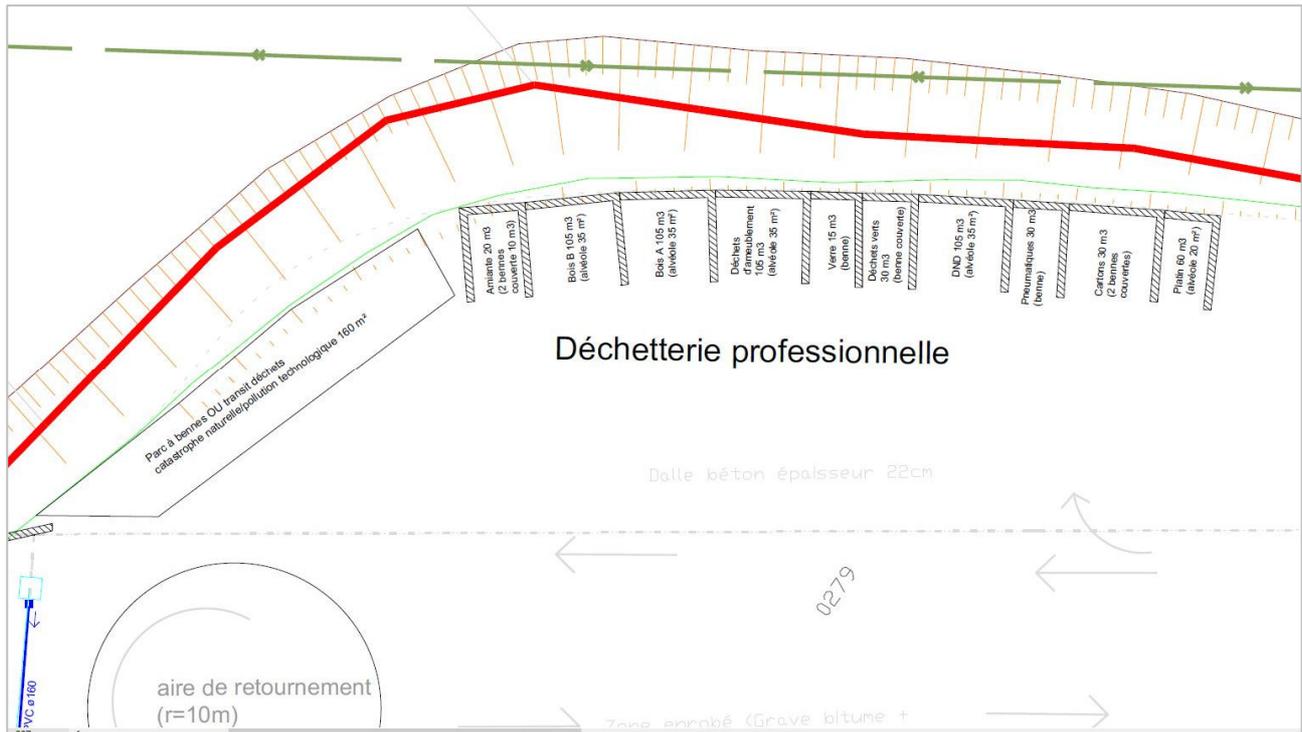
Zone déchetterie professionnelle (extrait plan d'ensemble)
